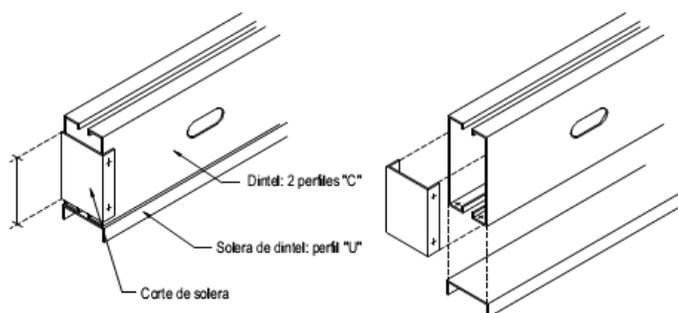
Armado de la viga tipo dintel para los vanos de puertas y ventanas. Fuente: ConsulSteel.
